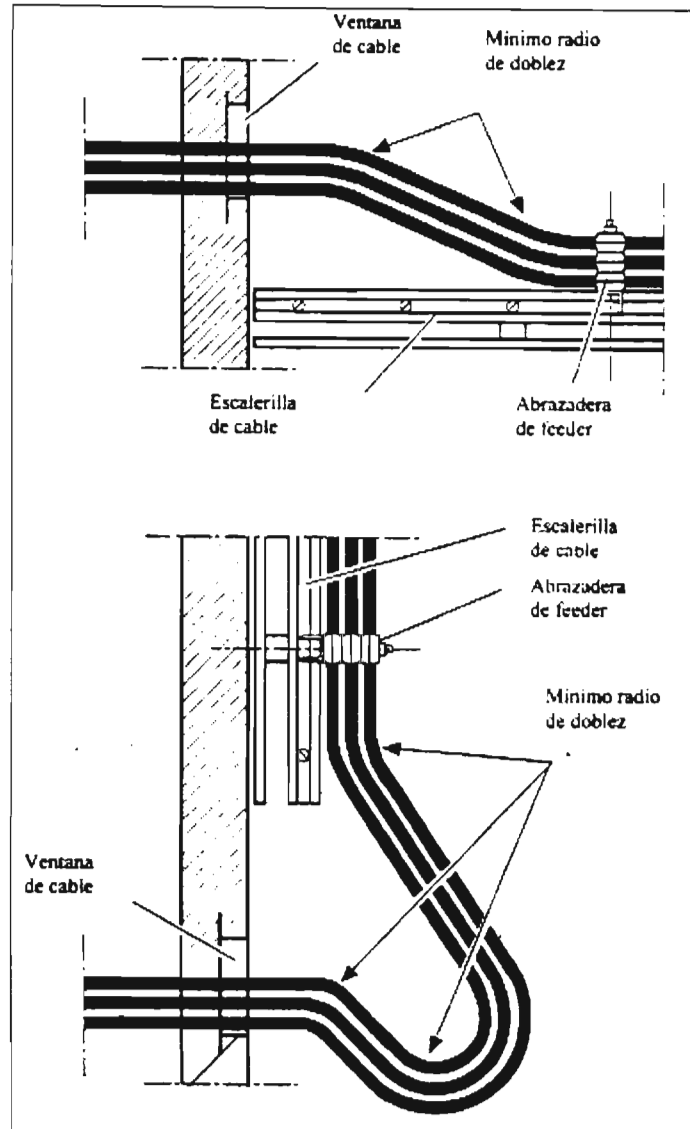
Colocación de los cables a través de la pared desde una escalerilla horizontal y vertical.
